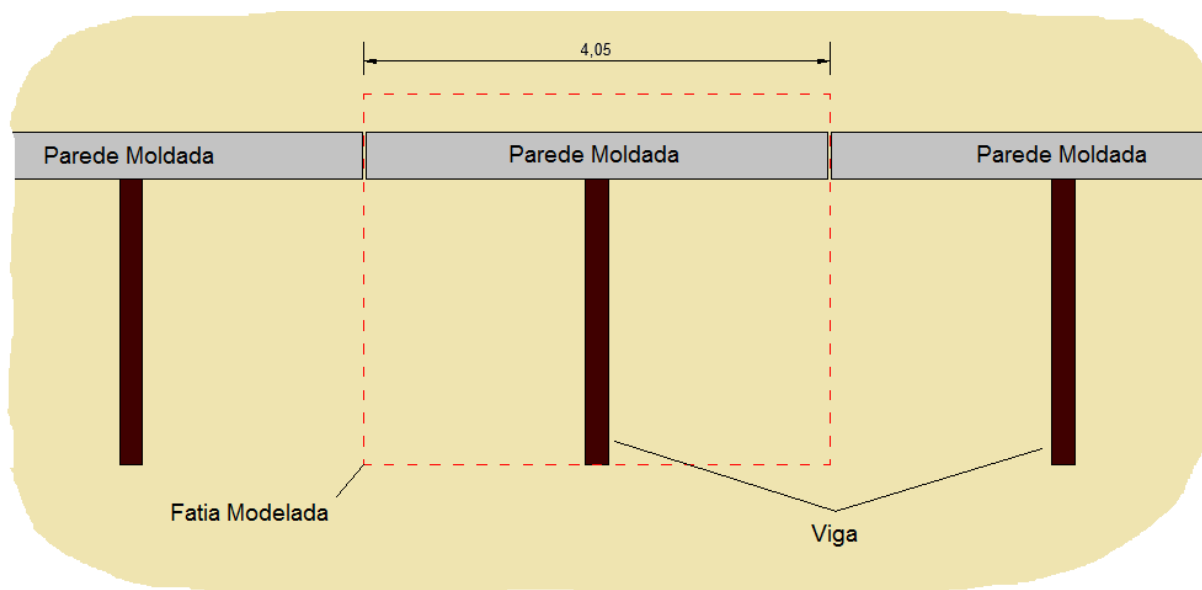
Escavação da estação Cais do Sodré no plano horizontal e fatia modelada (a tracejado).
